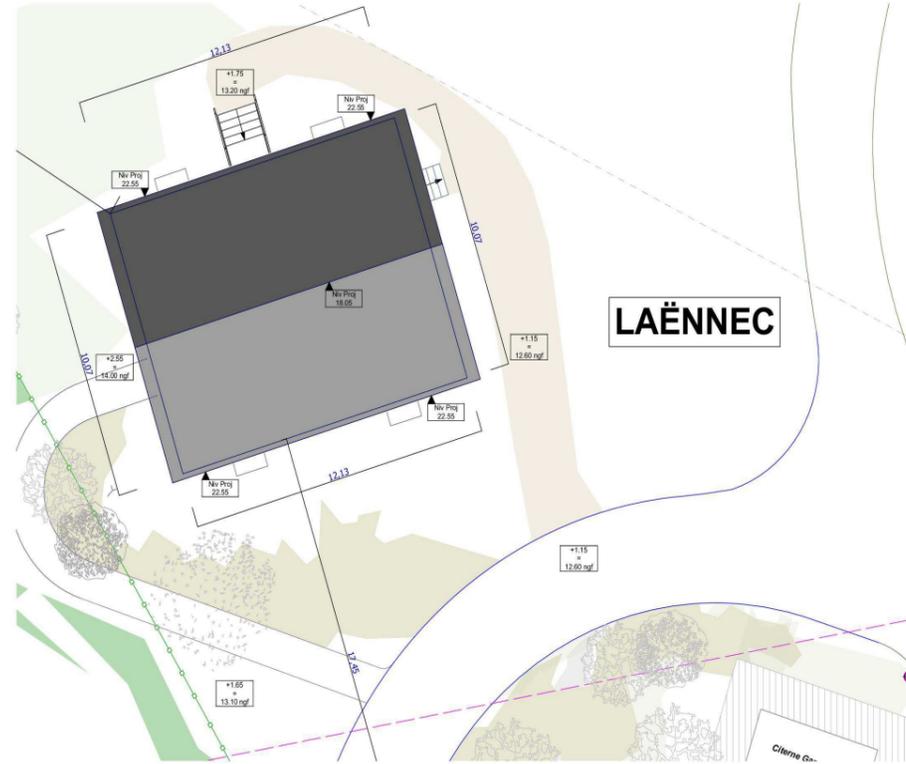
Plan masse du Château (Source : Paumier Architectes Associés)
